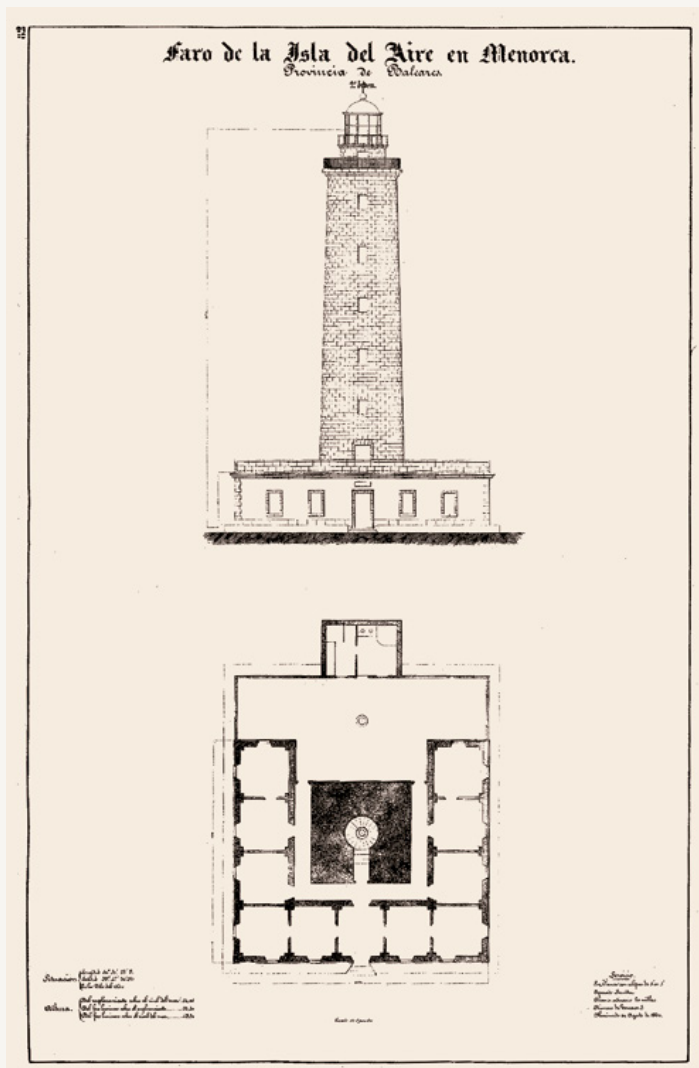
Planimetría faro de la Isla del Aire en Menorca, España.
